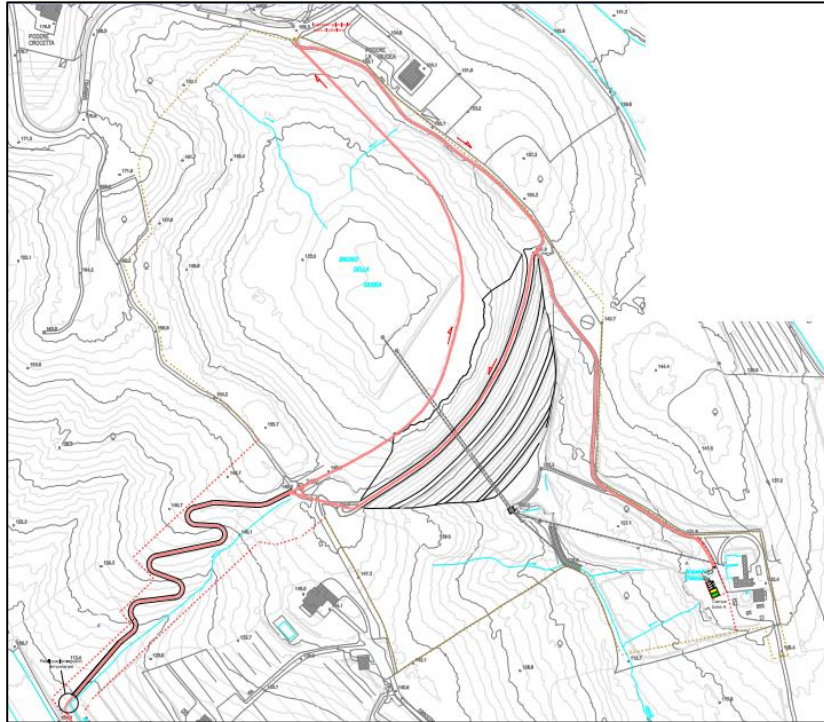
Estratto della Tav. EG45a- Viabilità di cantiere Fase 2, 3
